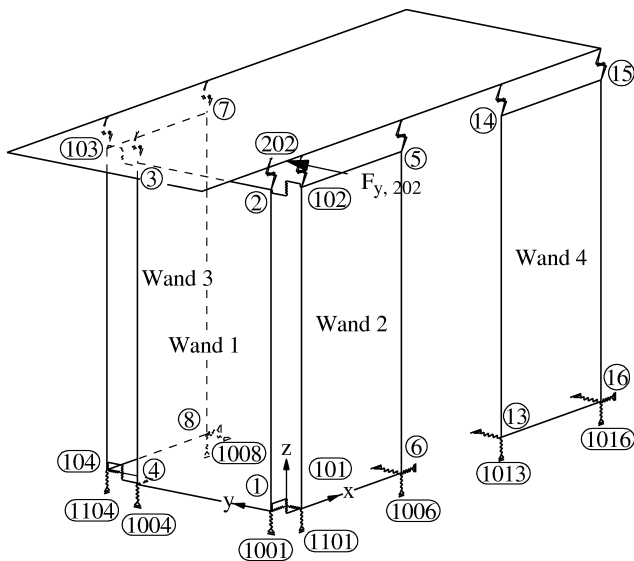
Verbindungen und Knotenbezeichnungen Wandstellung U+1
